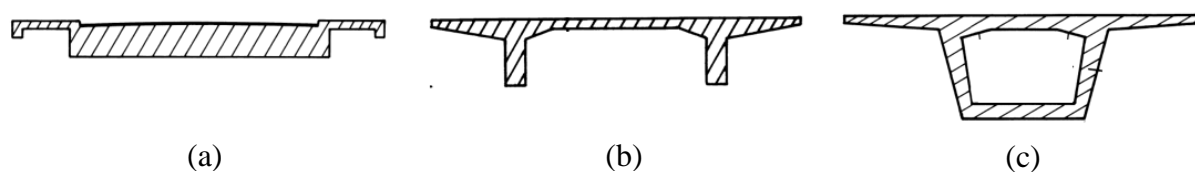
Sistemas Estruturais de Tabuleiros em Betão Armado Pré-Esforçado (adaptado de Reis (2006))
